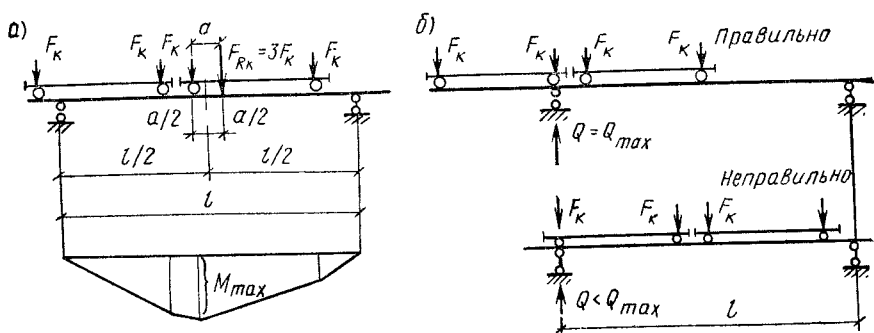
К определению расчетных усилий в разрезных подкрановых балках
